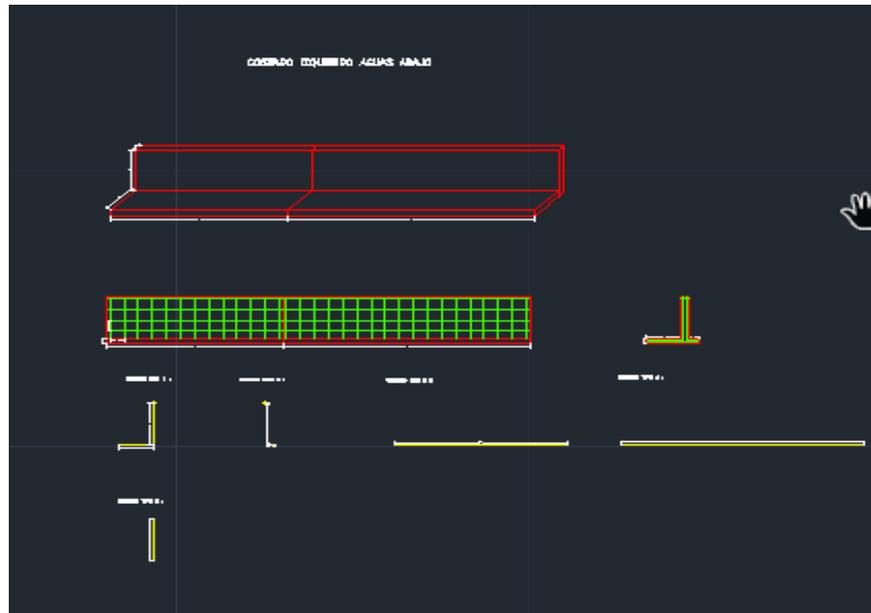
Despiece costado izquierdo mejoramiento sector Cartagua.
